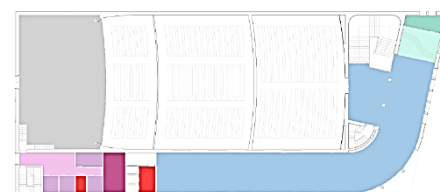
Planta do existente do Cinema de Arrifana, 2º piso.
